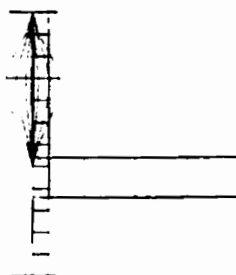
Poutre avec raidisseurs transversaux simples, section
